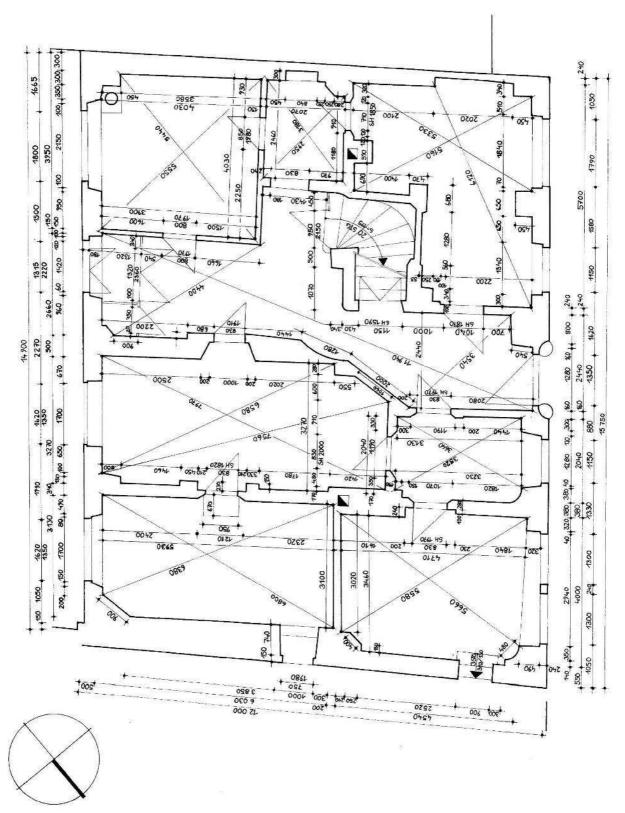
Webergasse 1, Grundriss Erdgeschoss vor der Sanierung
